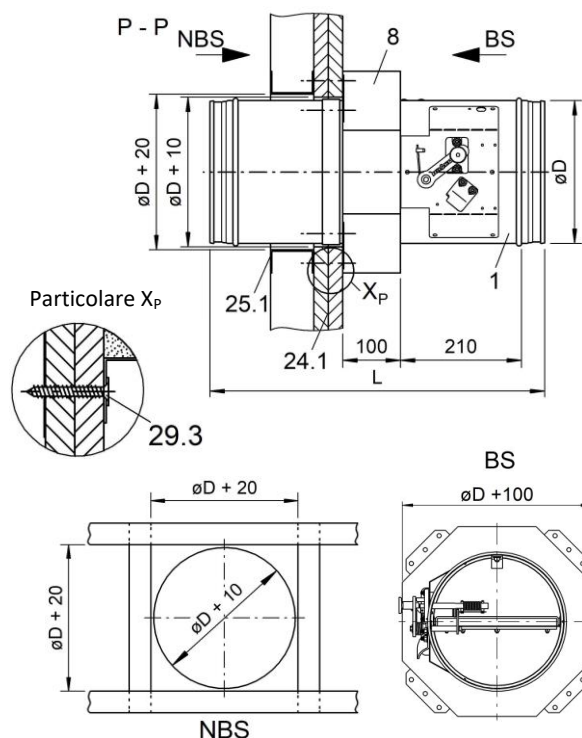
montaggio a secco con telaio AR su parete pozzetto
